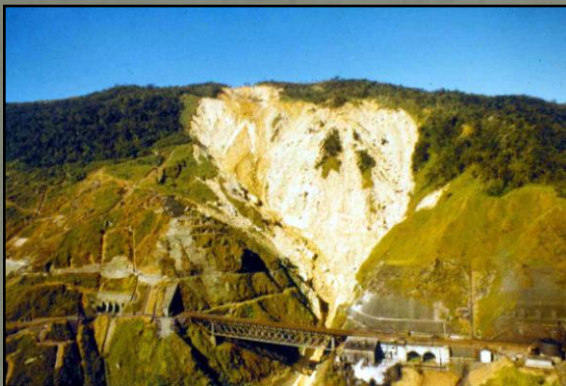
Escorregamento em cunha ou Estruturado.p.36
